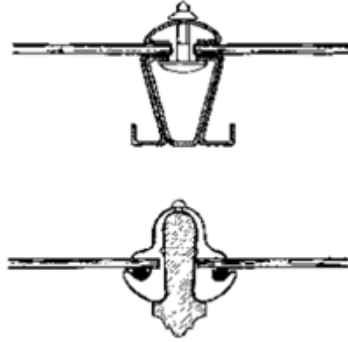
Chrysler Binası cephe detayı ve kullanılan elemanlar [13]
